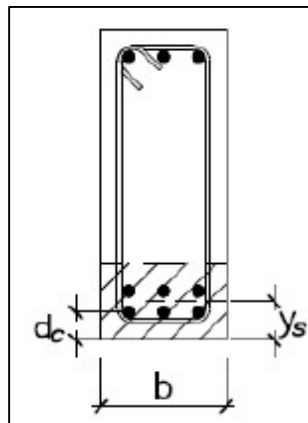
Sección de viga donde se muestra el área efectiva (NTE E.060, 2009).
